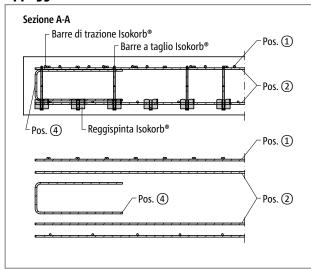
Schöck Isokorb® tipo KXT: armatura in opera, lato balcone, in sezione A-A; Pos. 4 = bordura costruttiva sul bordo libero
